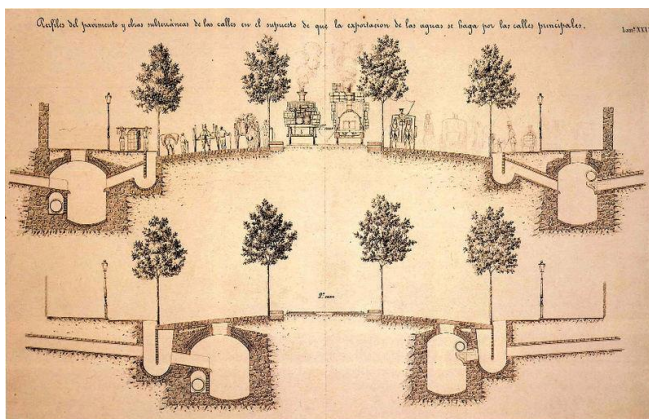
Barcelona: seção do Eixample (projeto de Cerdá).
